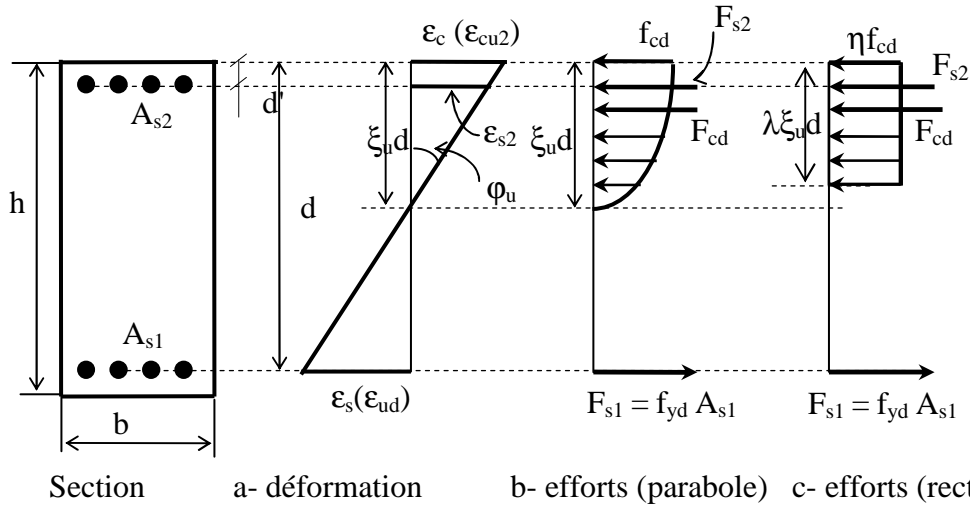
Comportement de la section d'une poutre fléchie en béton armé à l'état limite ultime
